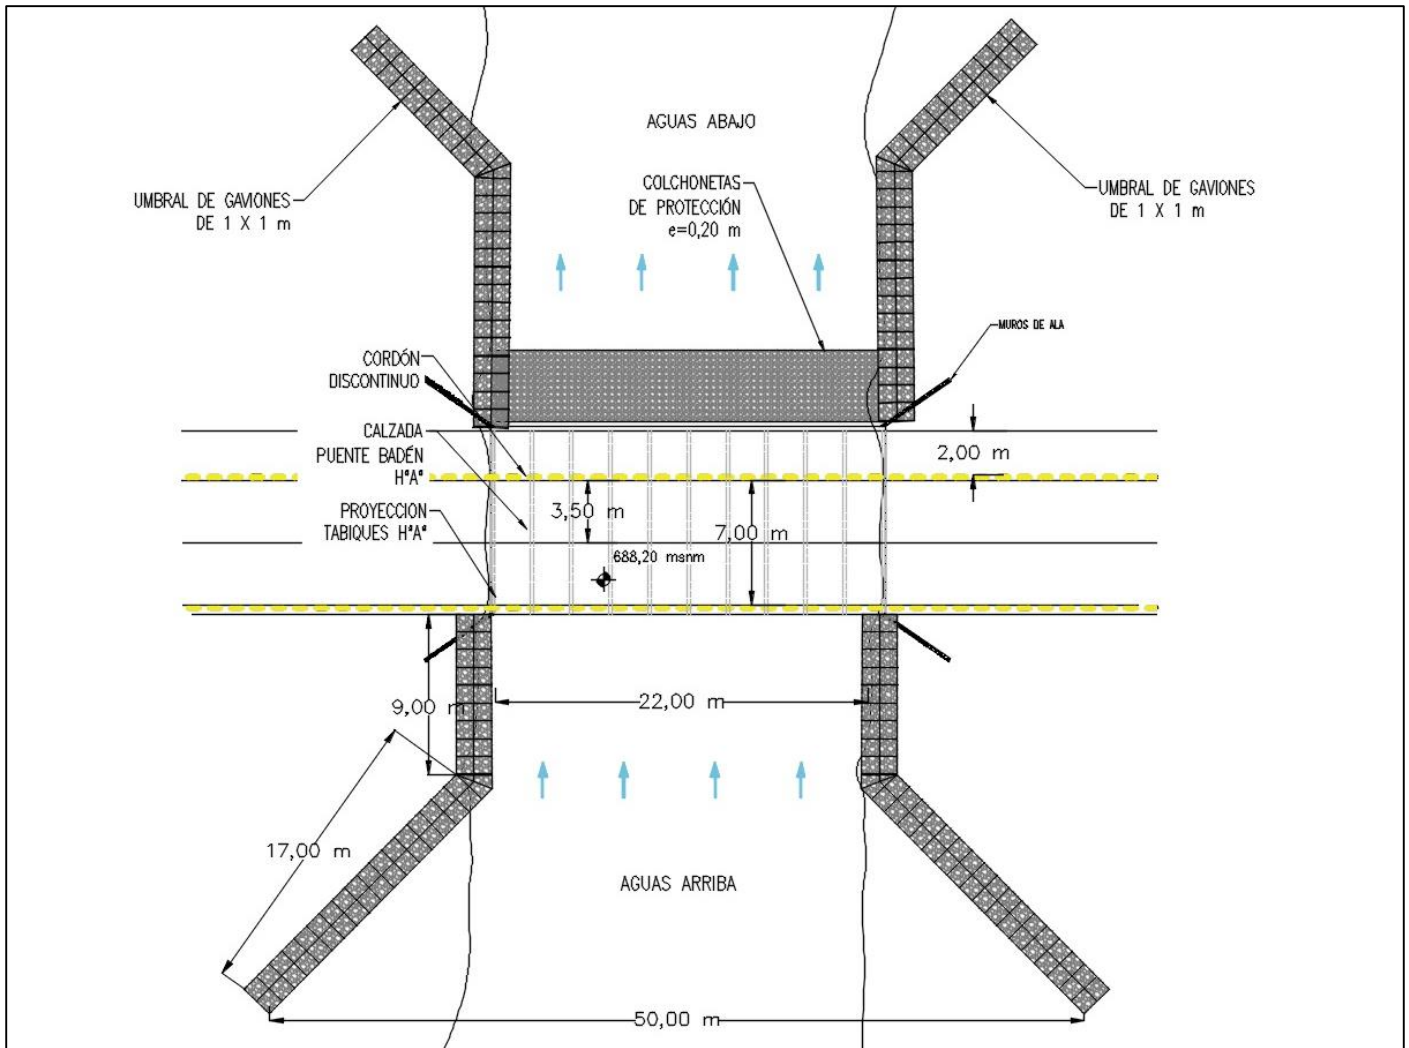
Planta de alcantarilla y obras de protección, (sin escalera)
